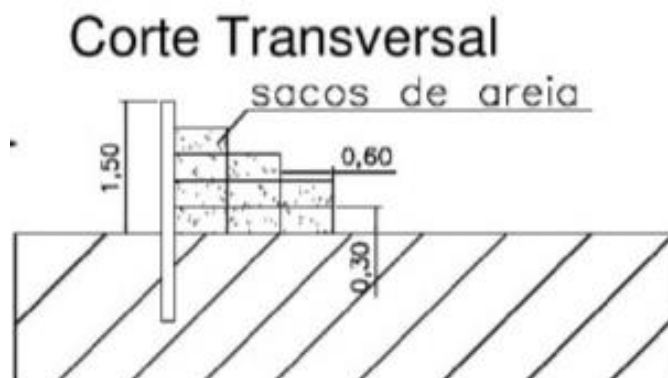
Fixação do modelo construtivo de paliçada proposto.
